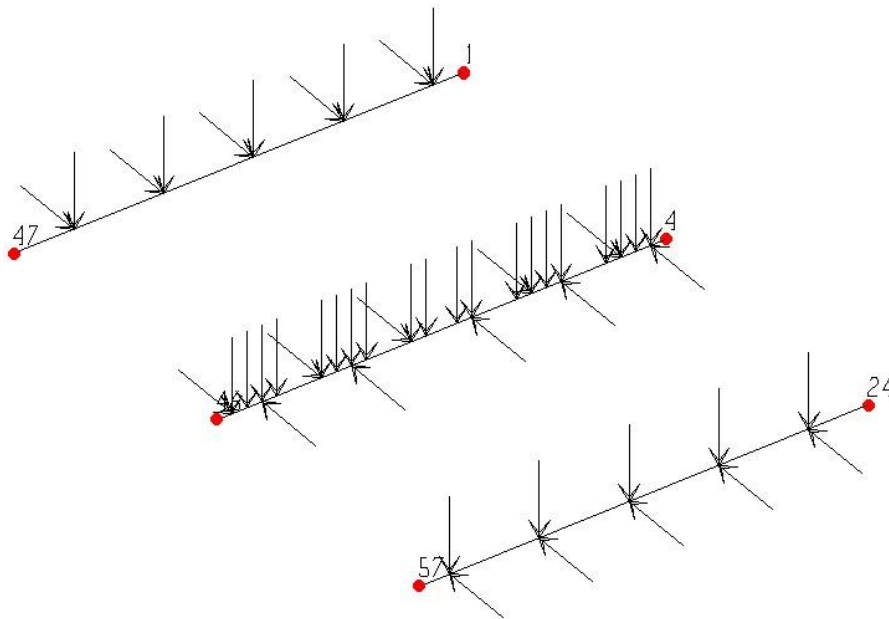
Aplicación de cargas puntuales en las vigas del pórtico central y los dos pórticos laterales
